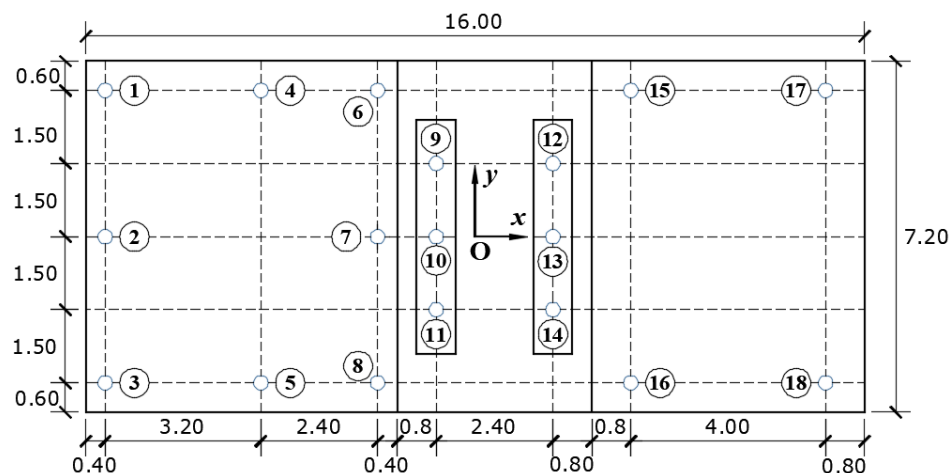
Geometría en planta de la fundación y puntos de carga del equipo
